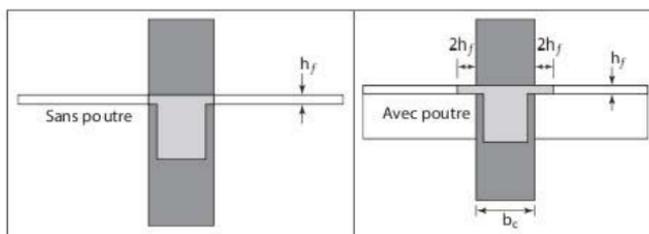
Largeur participante b_{eff} des membrures de poutres connectées aux poteaux de rive
